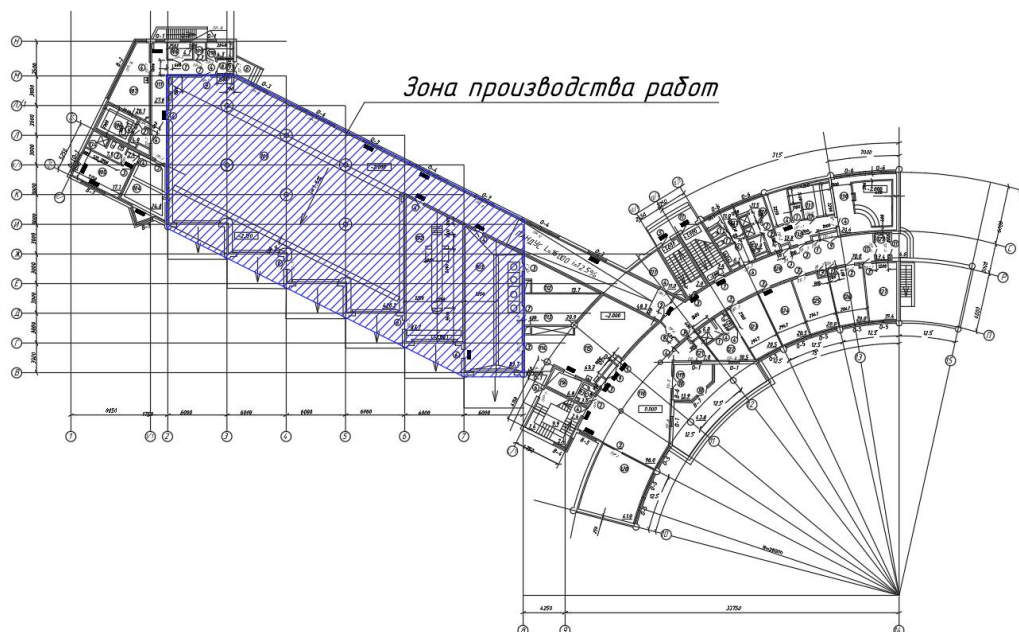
Схема расположения перекрытия на отм. 0,000
